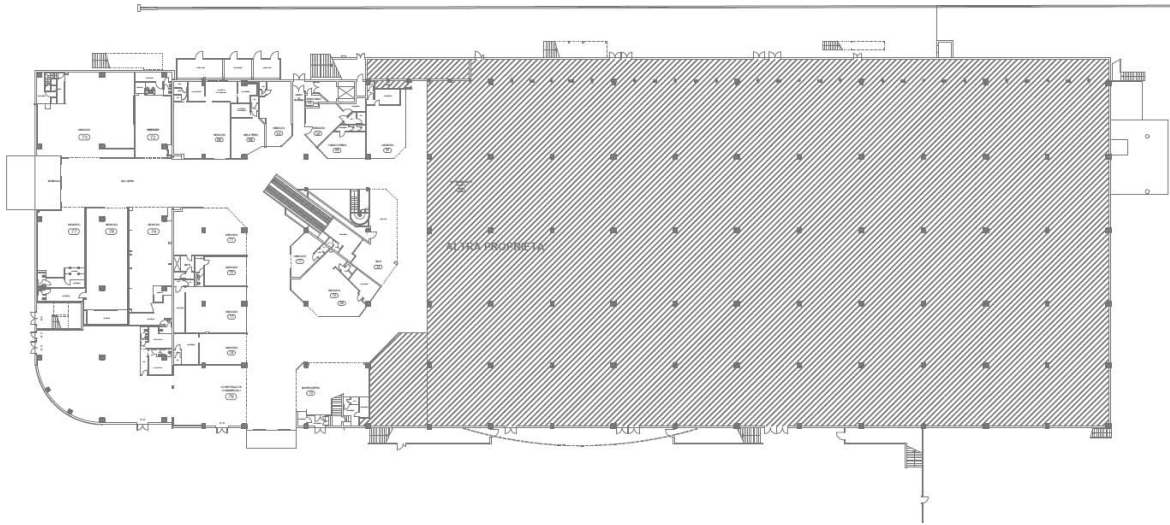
Centro commerciale Tiziano, pianta piano terra, area tratteggiata porzione di altre proprietà con attività alimentare.
